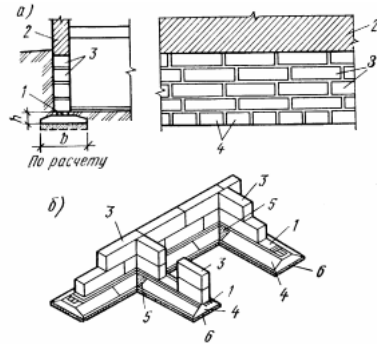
Стрічковий збірний фундамент із великих блоків:
